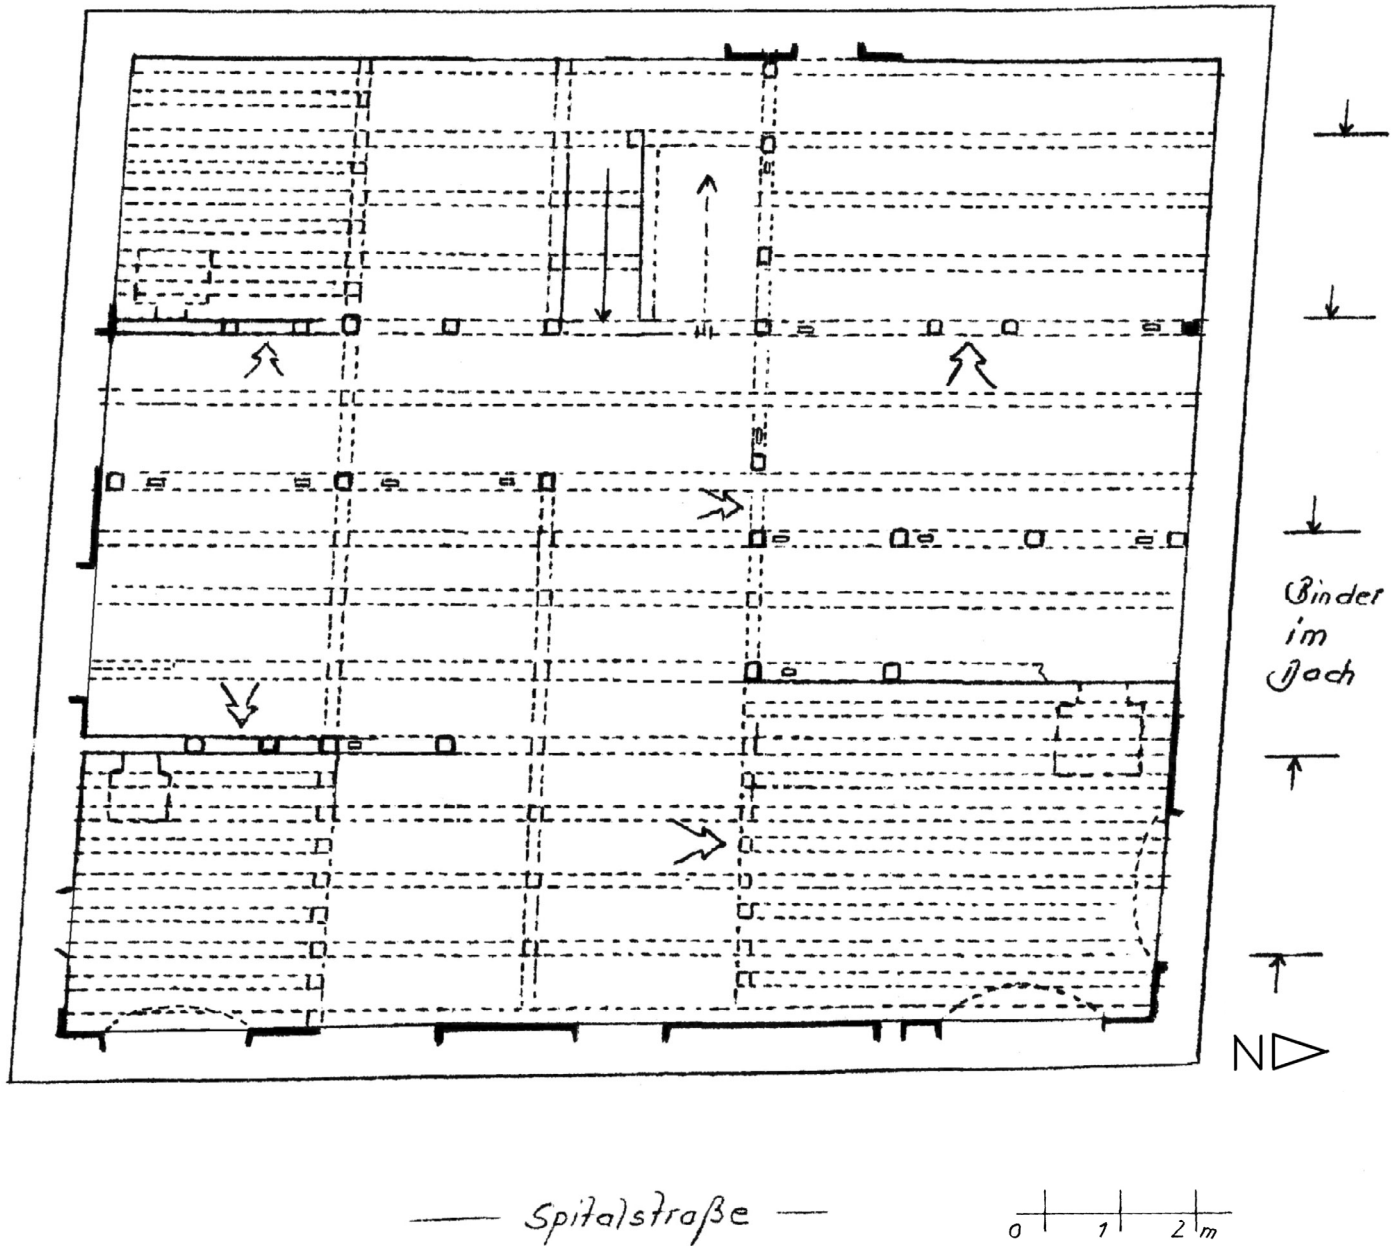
Spitalstraße 33, Grundriss 1. Obergeschoss mit bauzeitlicher Gebälklage und Ständerstellung, um 1580 (d).
